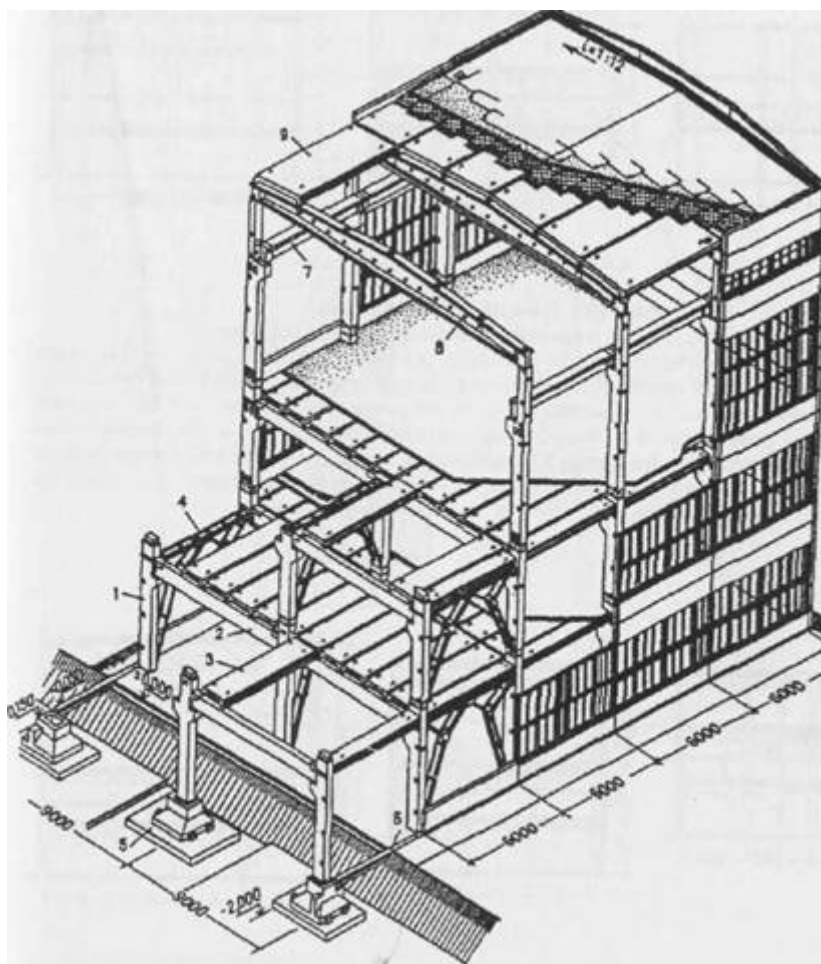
Полный сборный железобетонный каркас многоэтажного промышленного здания с перекрытиями балочного типа:
